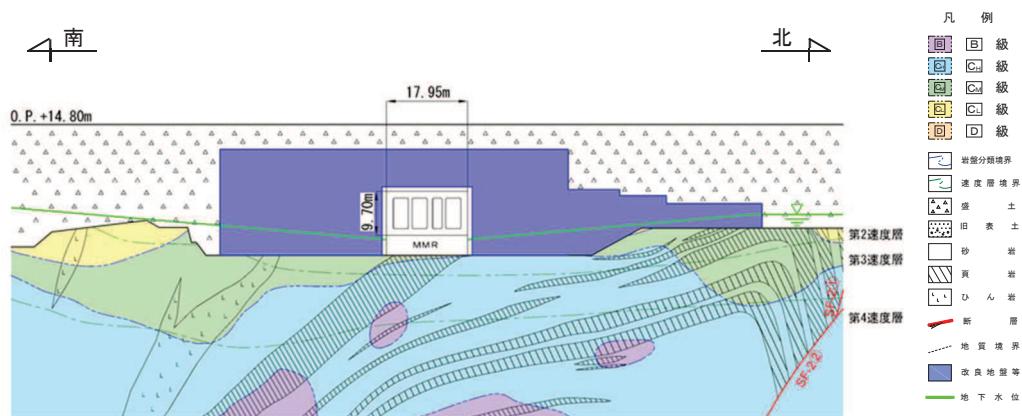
原子炉機器冷却海水配管ダクト（水平部）評価対象断面図
